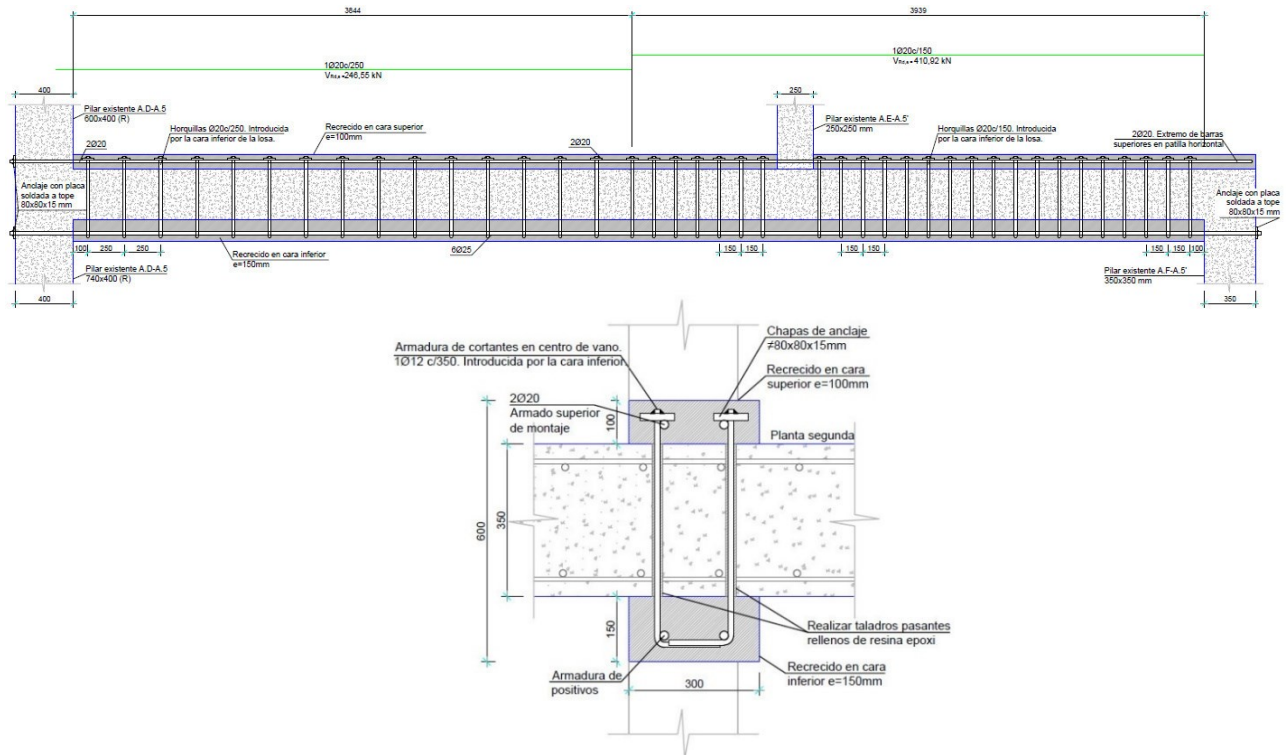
Refuerzo a cortante mediante viga de hormigón armado.
